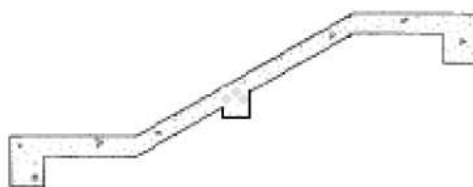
Sistemas de escaleras con apoyo intermedio
